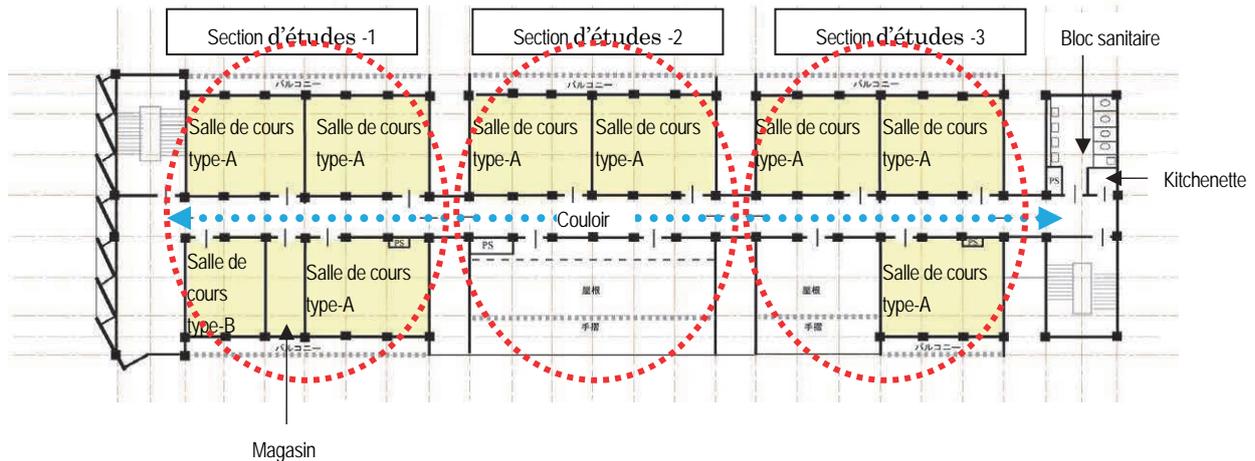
Vue en plan du 1<sup>er</sup> étage
